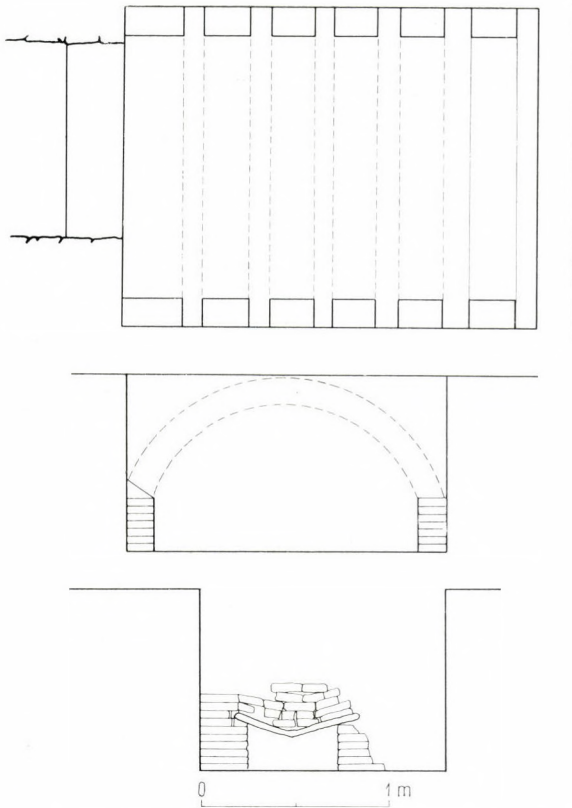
Grundriß und Teilansicht des Heizraumes Nr. III. Anfang des 15. Jh.
